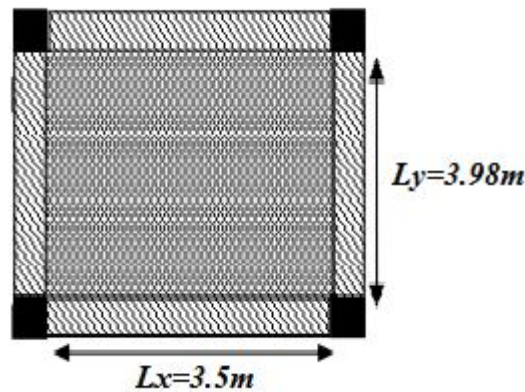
Présentation de la dalle la plus sollicitée.
